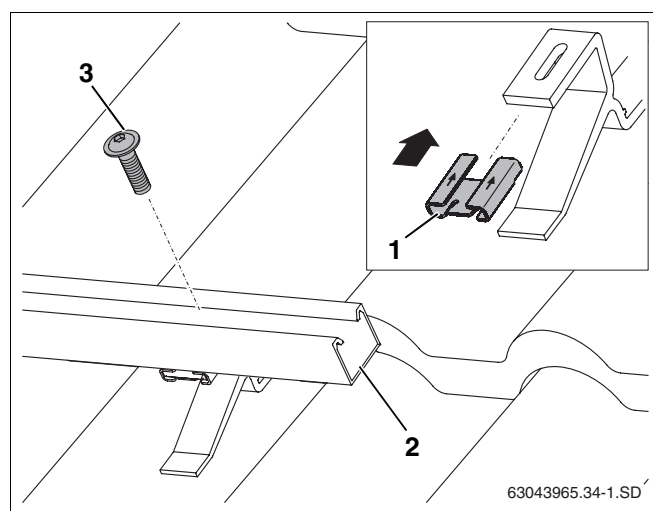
Fijación de los perfiles guía a los ganchos de tejado
